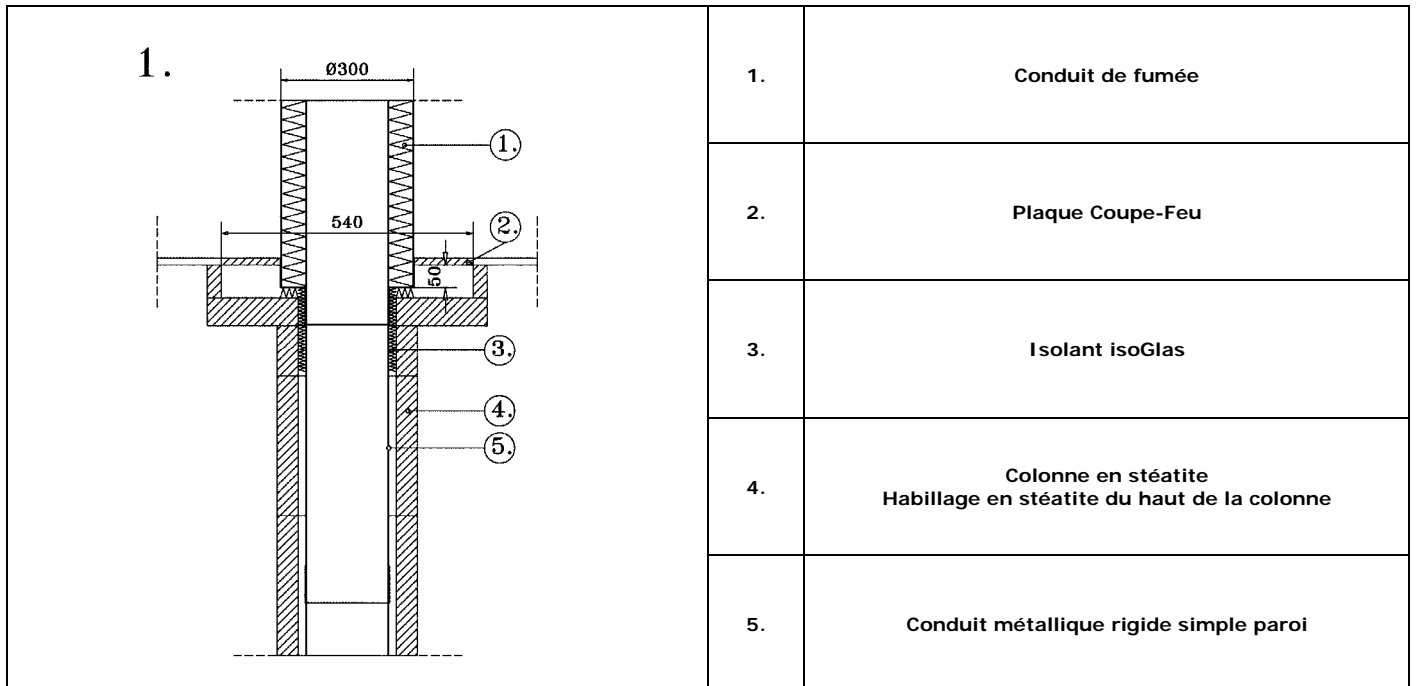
Jonction colonne en stéatite et conduit de fumée en attente au plafond
